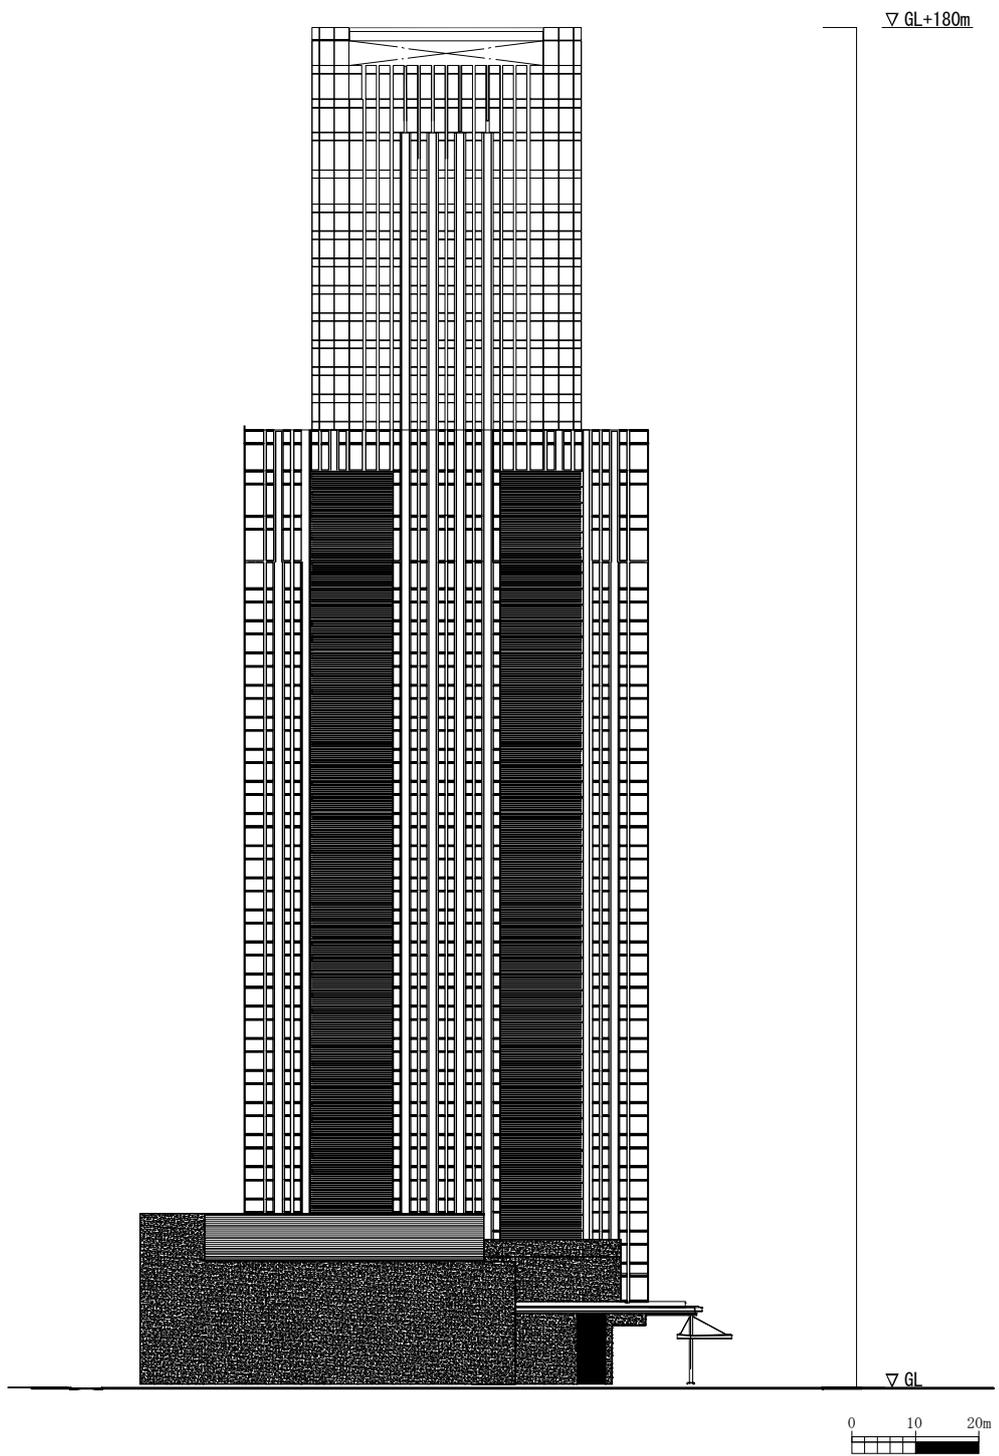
(6) 計画建築物立面図 (南側) (評価書(計画))
